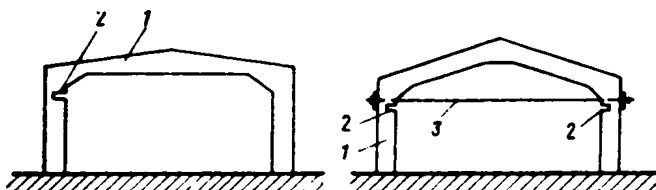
Преобразование статической схемы поперечной железобетонной рамы
